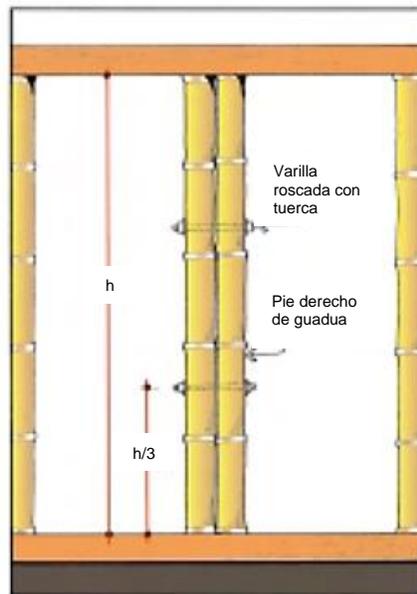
unión entre muros en un mismo plano. Fuente (AIS & FOREC, 2002)
